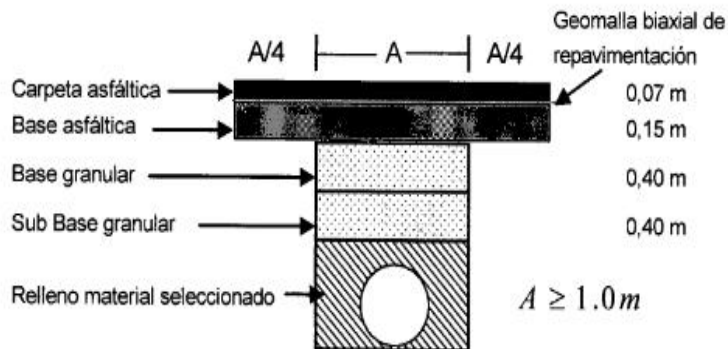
Estructura tipo de pavimento flexible, para intervenciones en zanja sobre vías arteriales e intermedias
